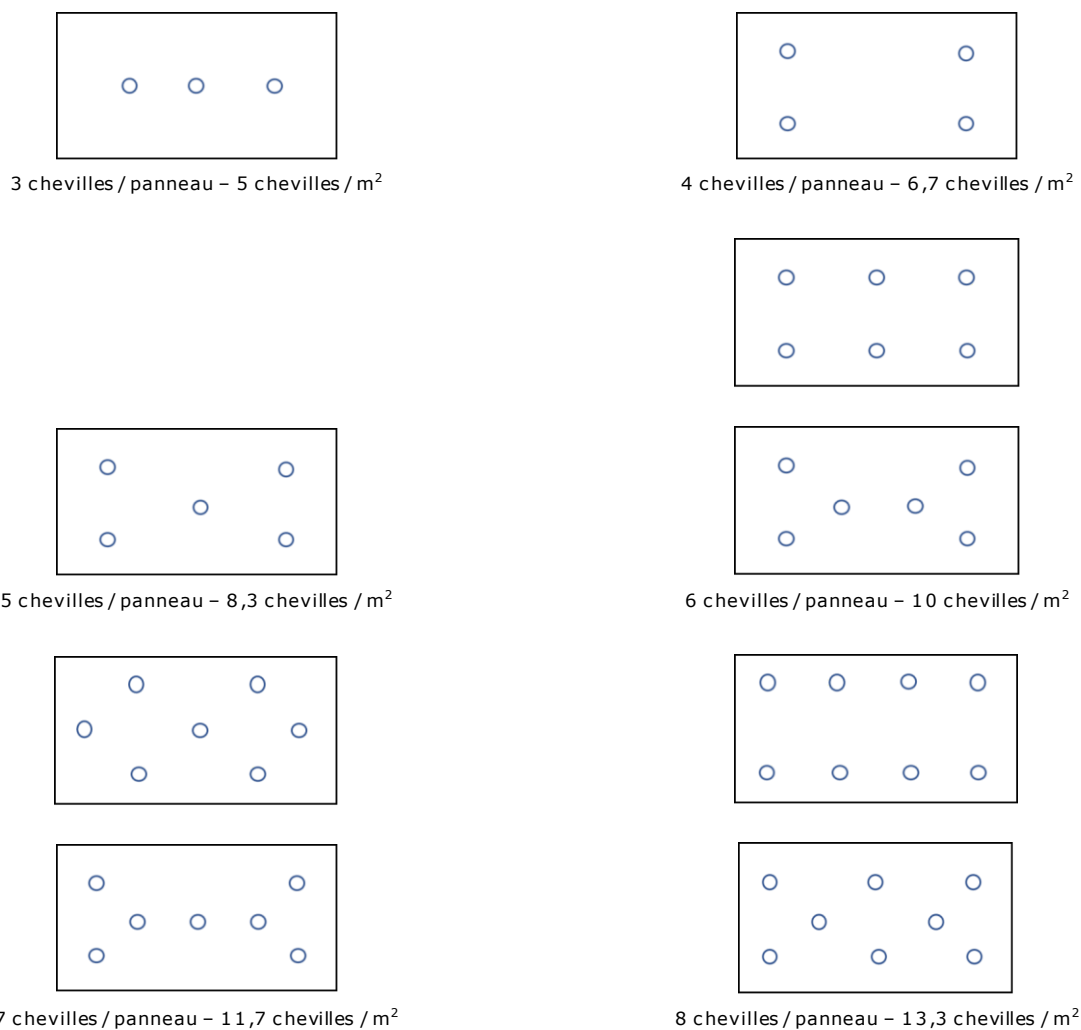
Plans de chevillage - panneaux de dimensions 1000 x 600 mm – Chevillage « en plein » (espacement entre chevilles ≥ 100 mm et distance au bord ≥ 100 mm)
